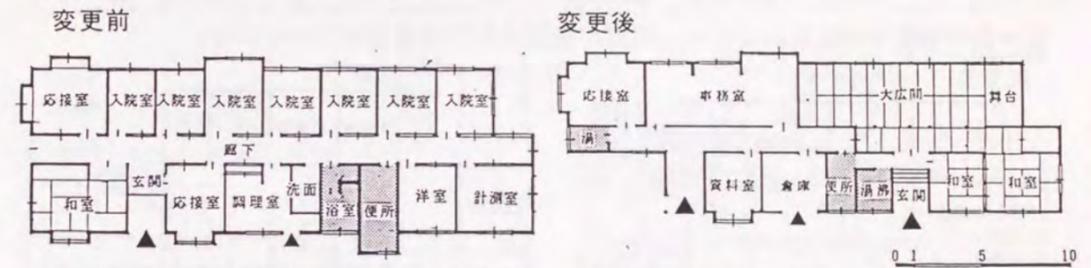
〈106〉瀬戸シルバー人材センター(旧助産センター)平面図
